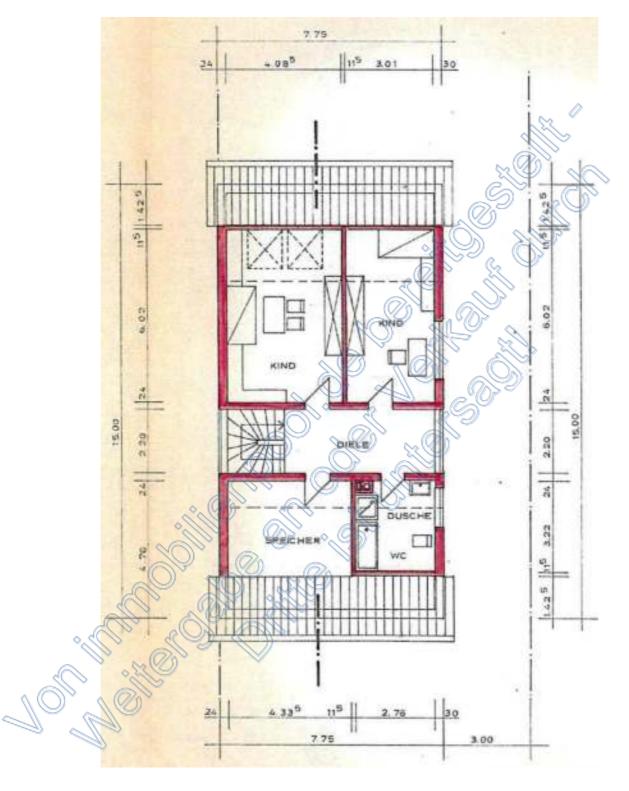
Grundrissplan Dachgeschoss (aus Bauakte 1973)
